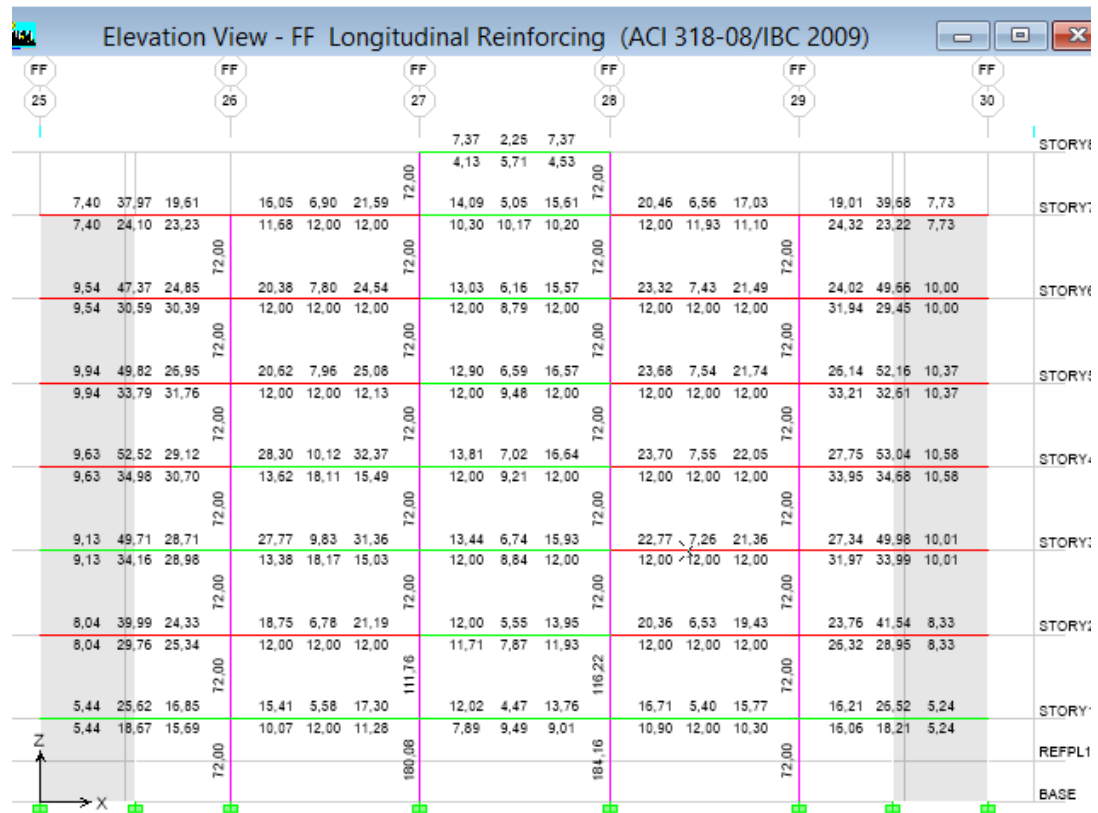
Acero en Vigas y Columnas en el Pórtico FF – Hospitalización 2- (CEC-2002)
